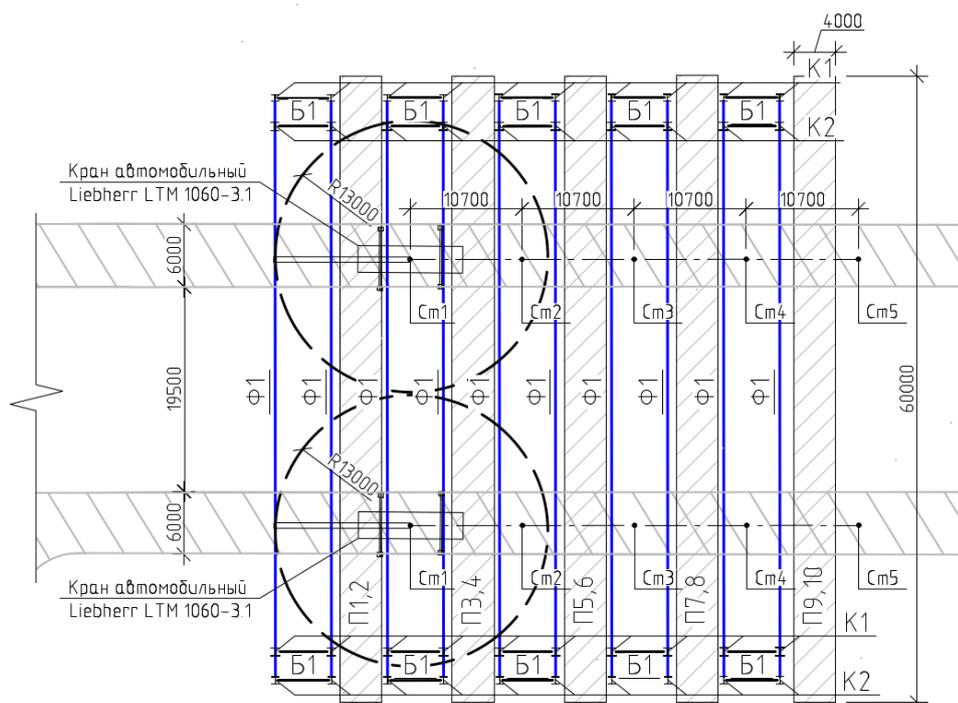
Схема стоянок крана и площадок укрупнительной сборки
